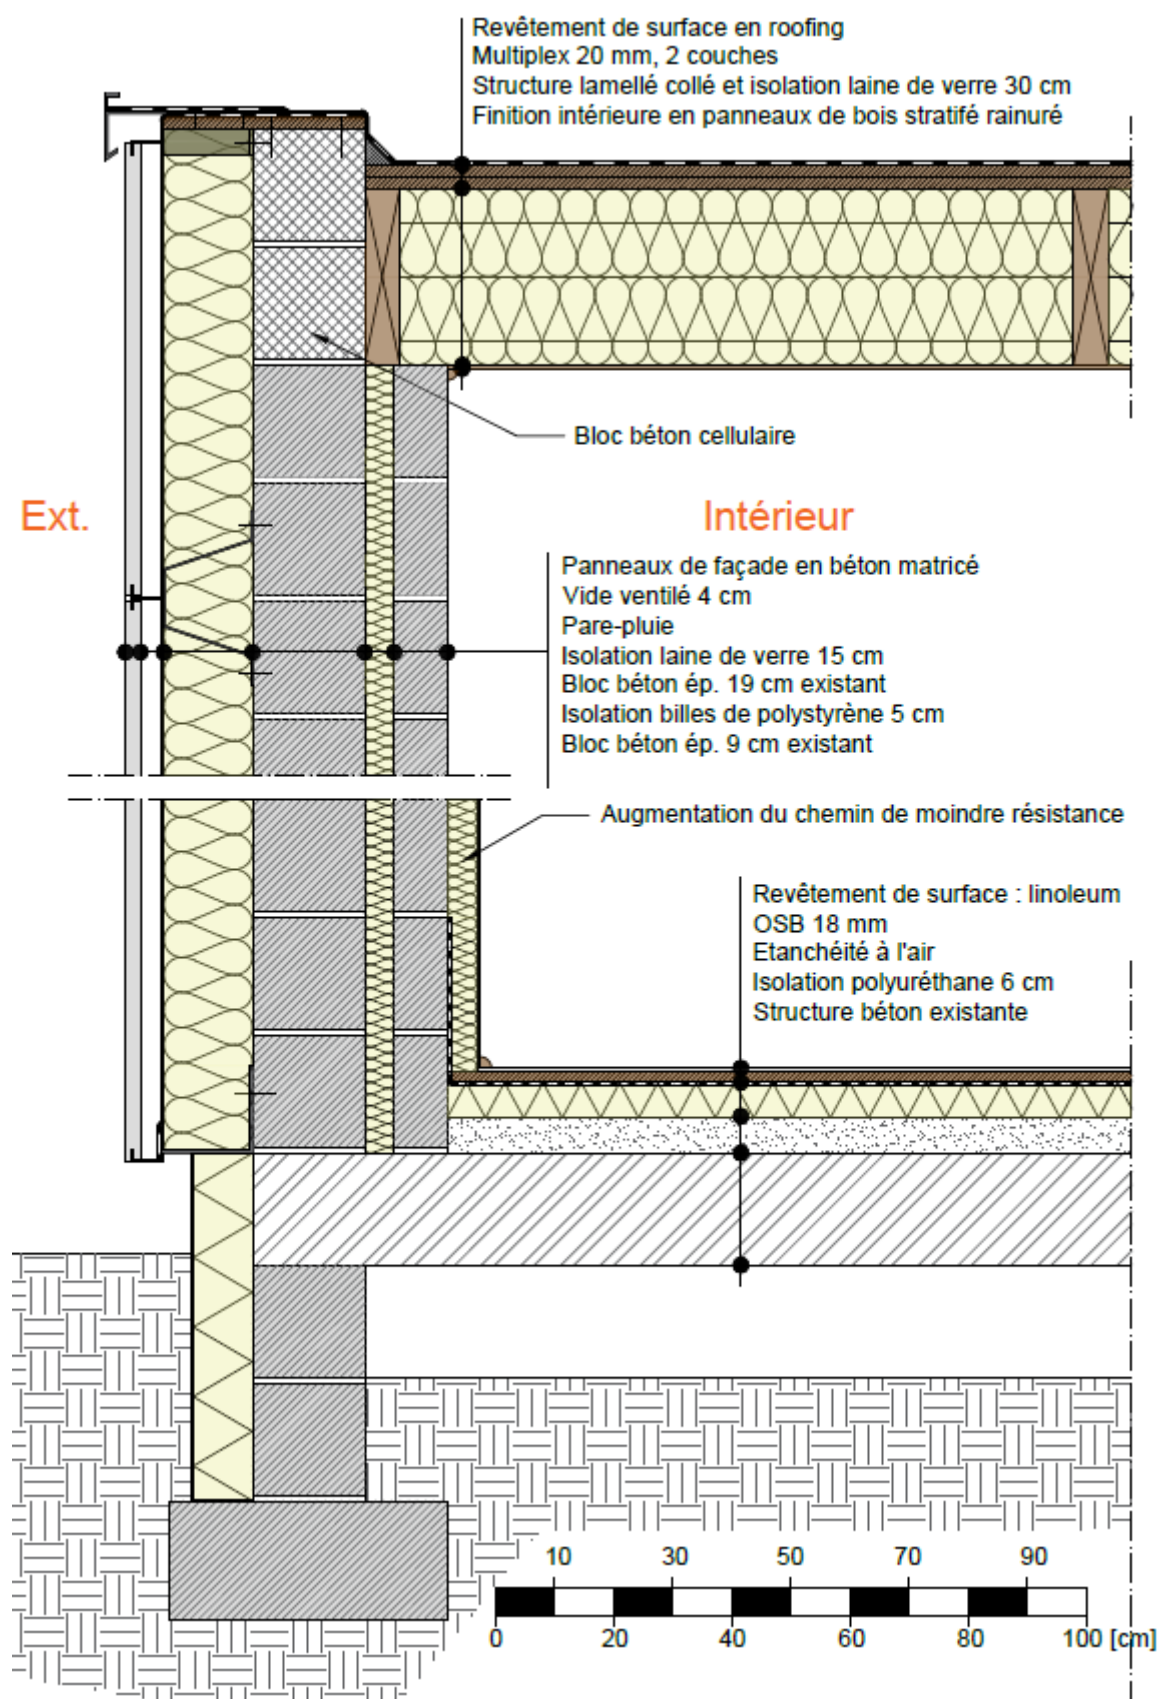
Coupe verticale : jonction plancher/façade et façade/toiture (scénario 1)
